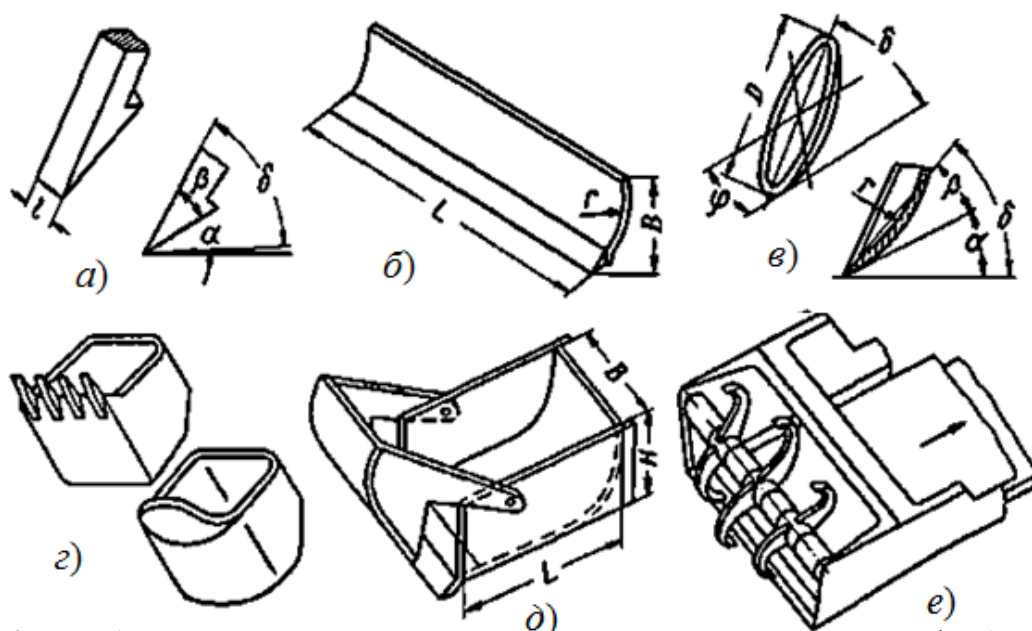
Рабочие органы землеройных машин: *а* - зуб; *б* - отвал с режущим ножом; *в* - дисковый нож; *г* - ковш экскаватора с зубьями и ковш экскаватора с полукруглой режущей кромкой; *д* - ковш скрепера; *е* - рабочий орган землеройной машины с роторным рыхлителем.
